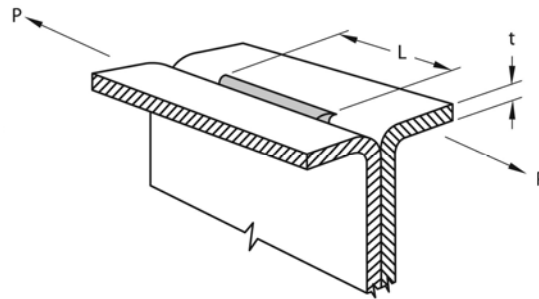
Cortante en soldadura abocinada en V
